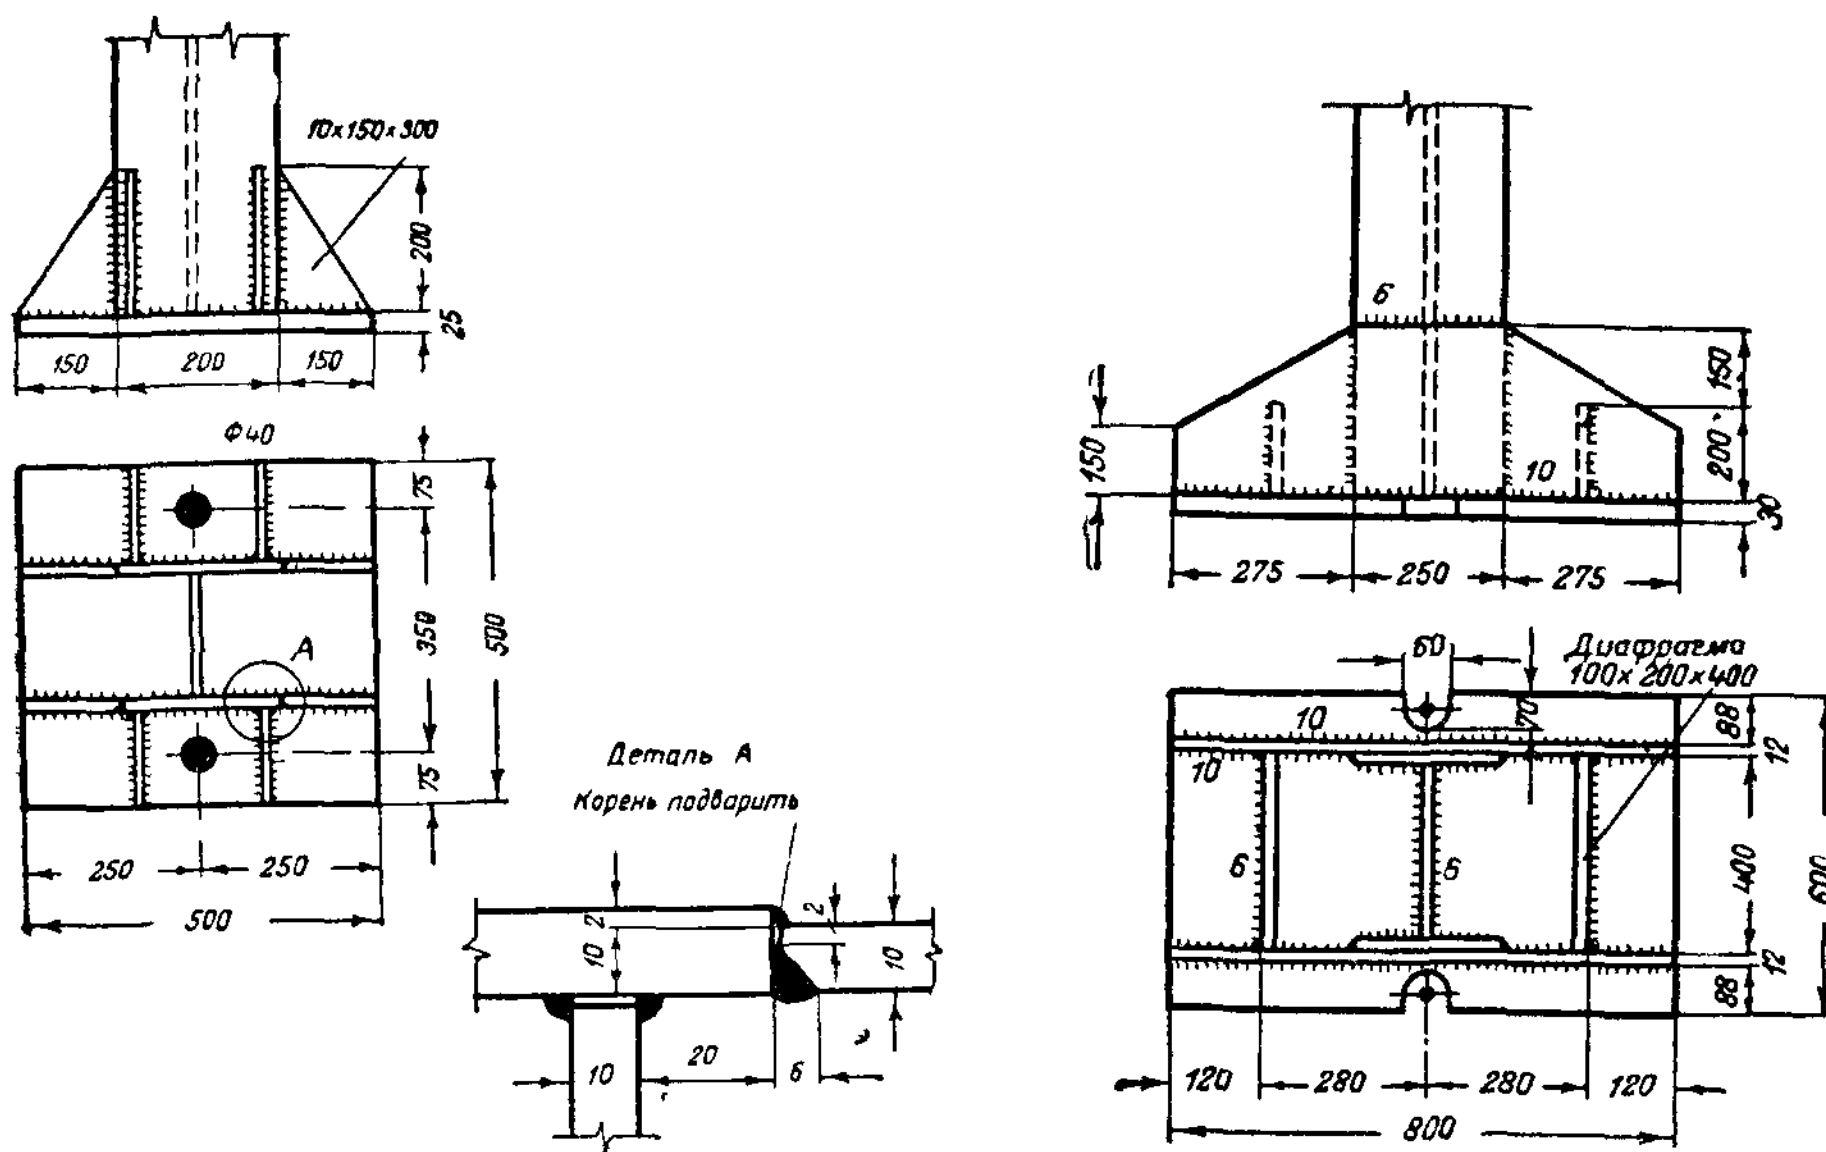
Сварная база с треугольными ребрами
